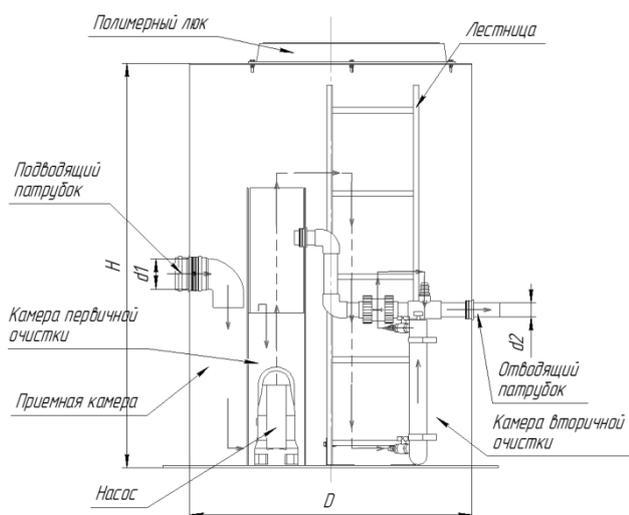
Габаритные размеры и основные части SANI-BF
